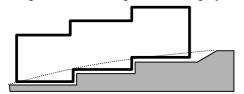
错层布置示意图(图片来源:作者自绘) Fig.11 Schematic diagram of staggered floor arrangement
